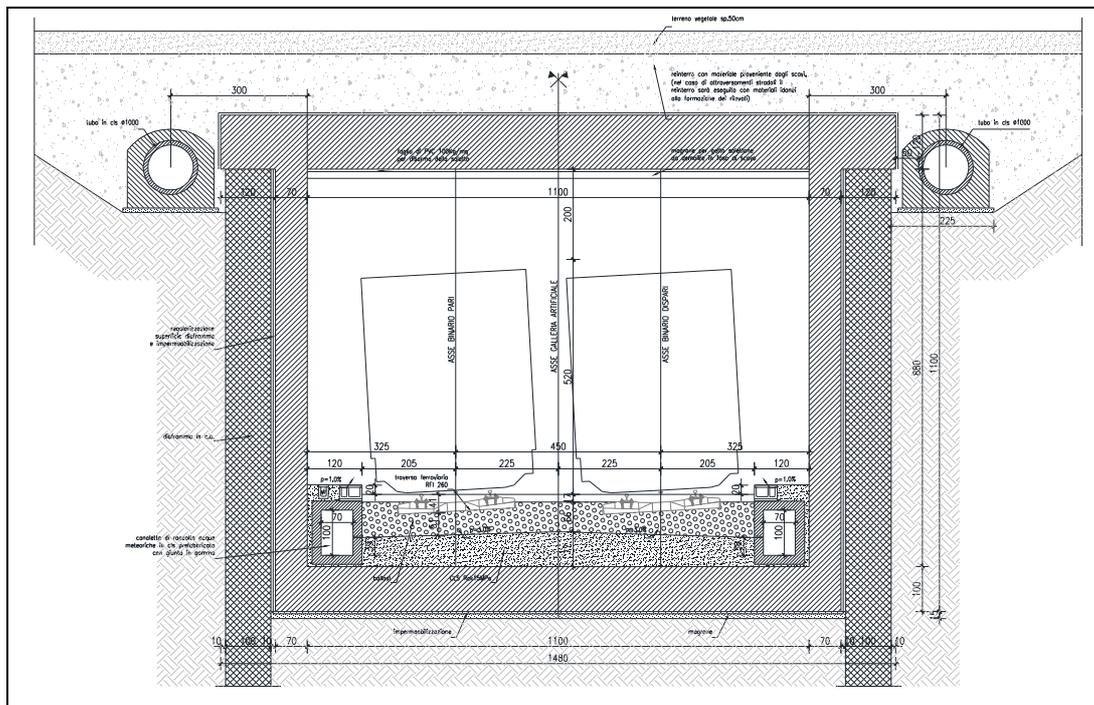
Sezione galleria artificiale nella zona in scavo fra diaframmi
